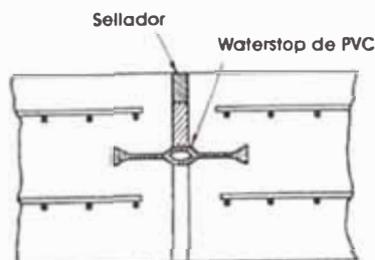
Detalles del diseño de juntas de expansión en estructuras de C°A°
